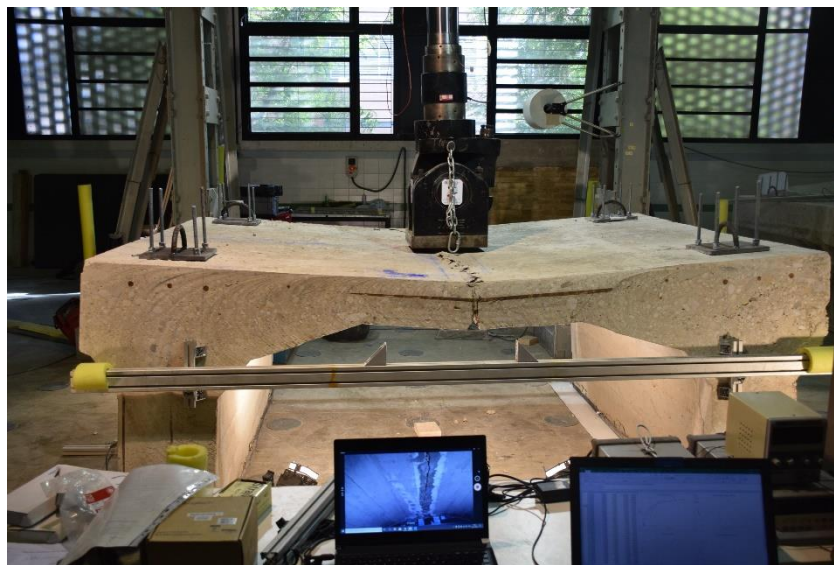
Estado final de la pieza PI 2 vista frontal.
